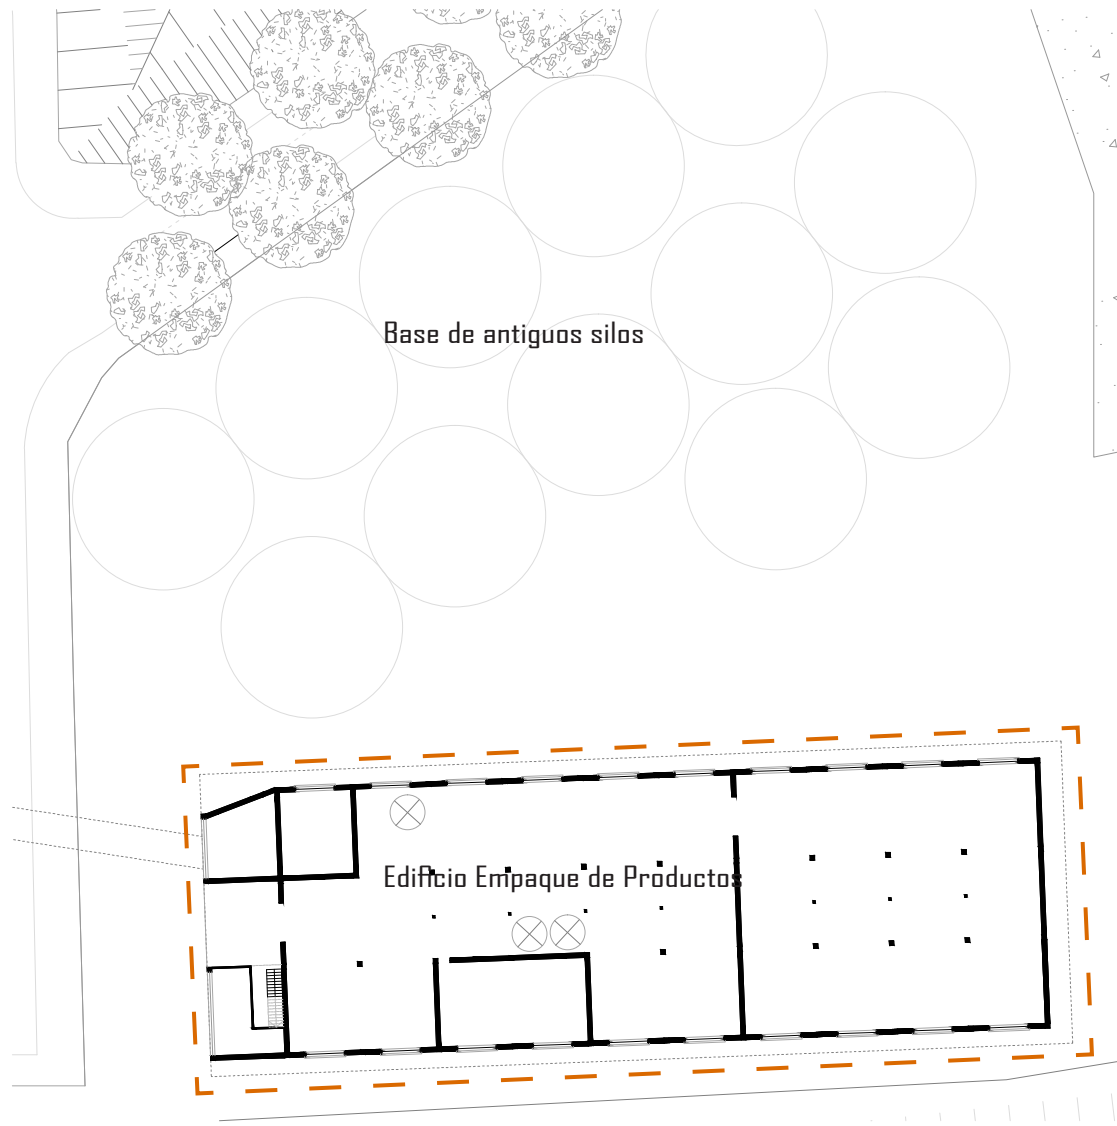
Planta Edificio 2, segundo piso y base de silos.
